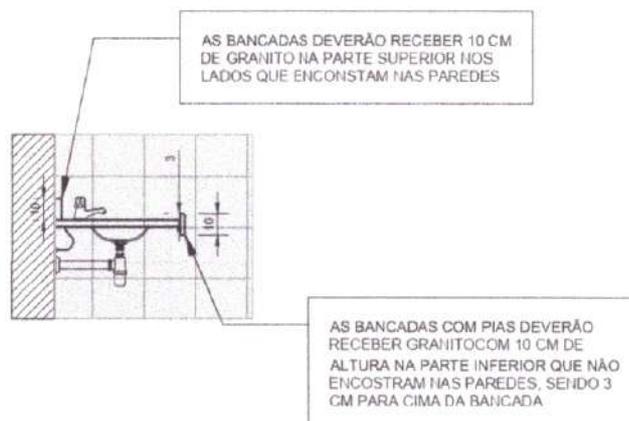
DETALHE DAS BANCADAS COM PIAS
